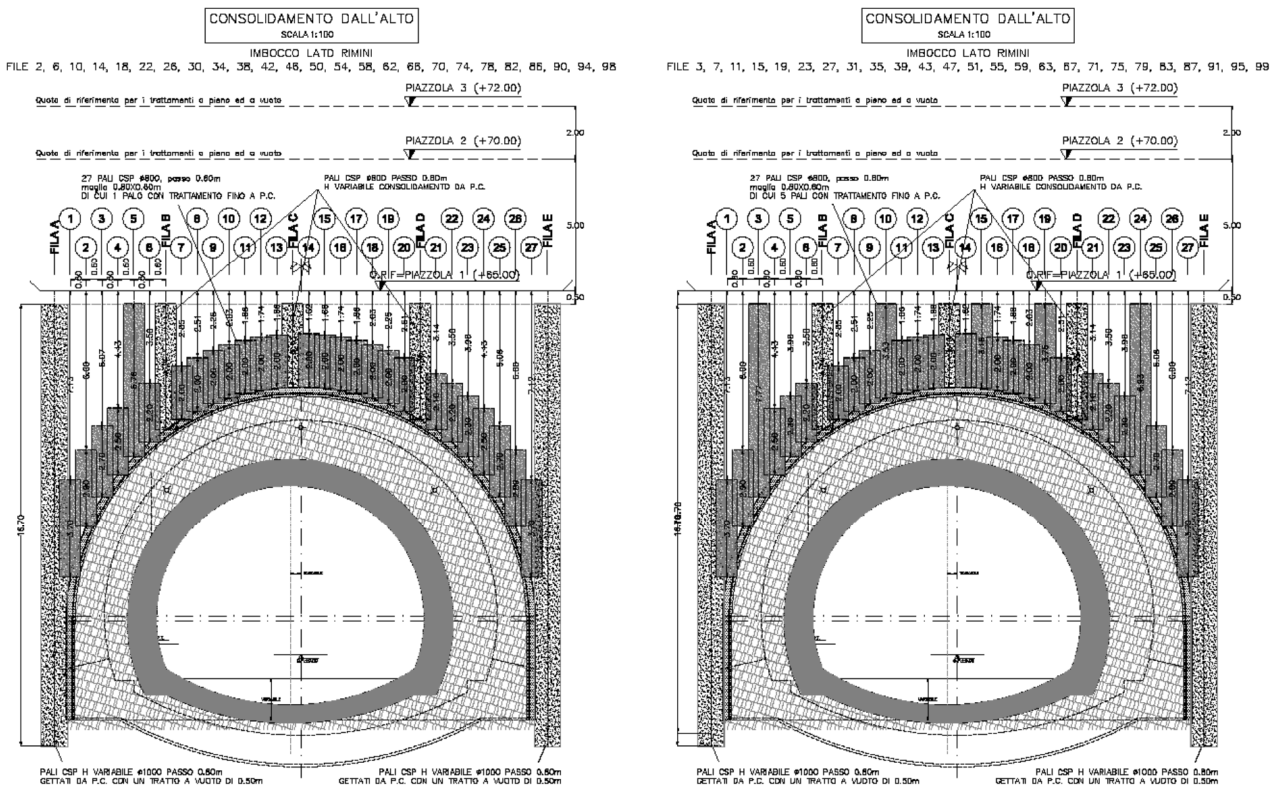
Sezione trasversale sezione tipo C1 dall'alto
